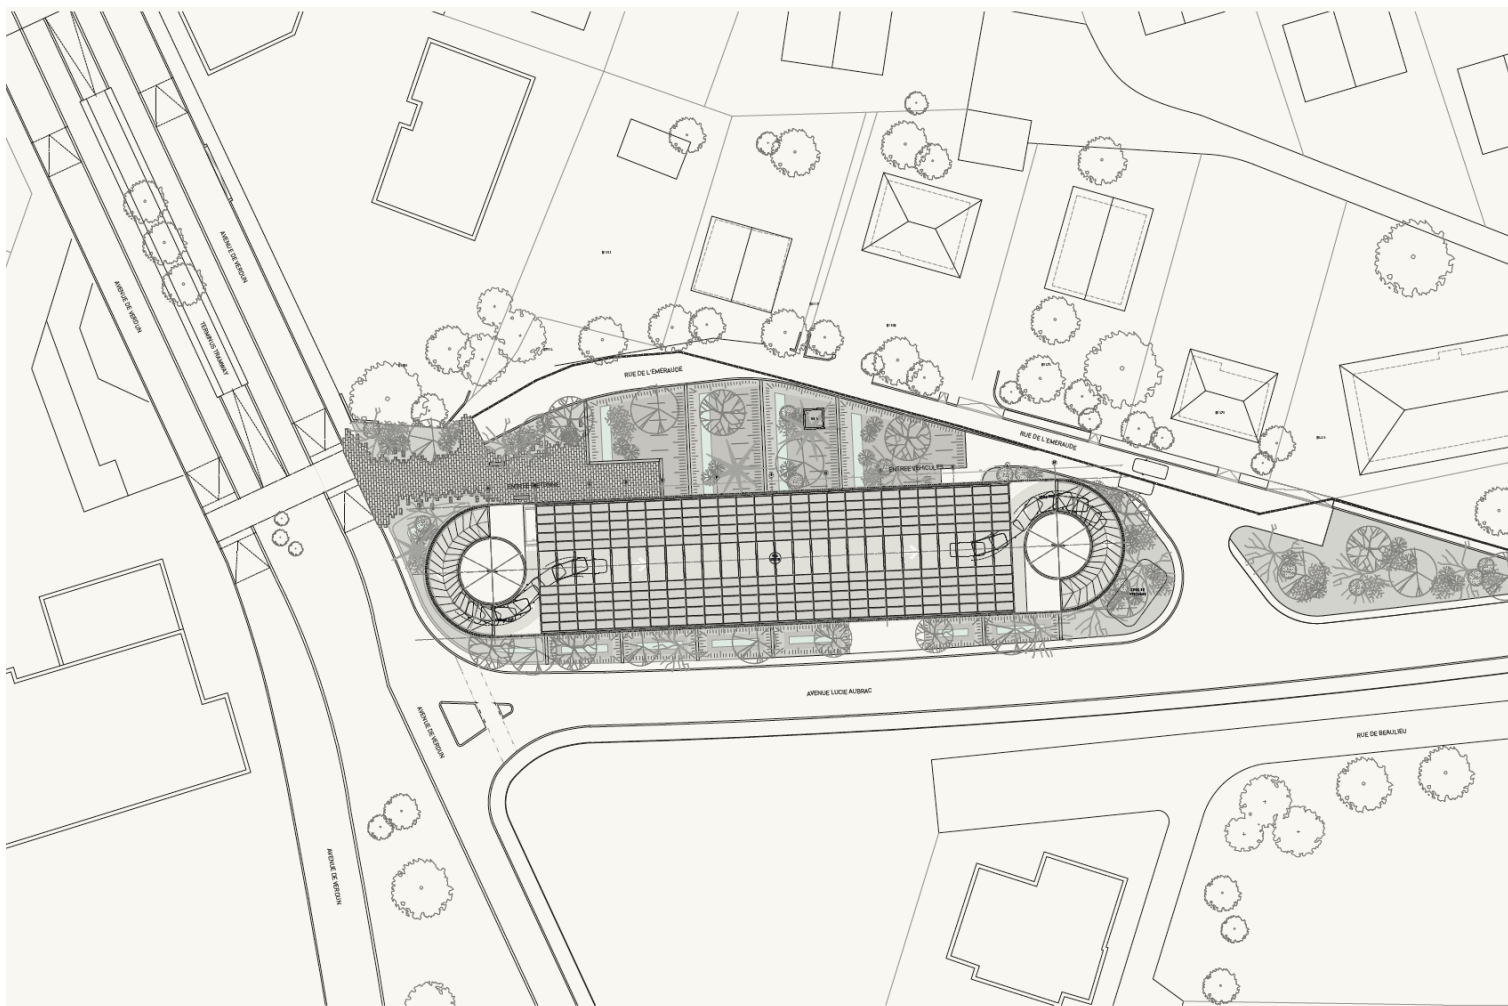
Plan du projet du P+R Aubrac (APS Clément Vergély Architectes, 2023).
